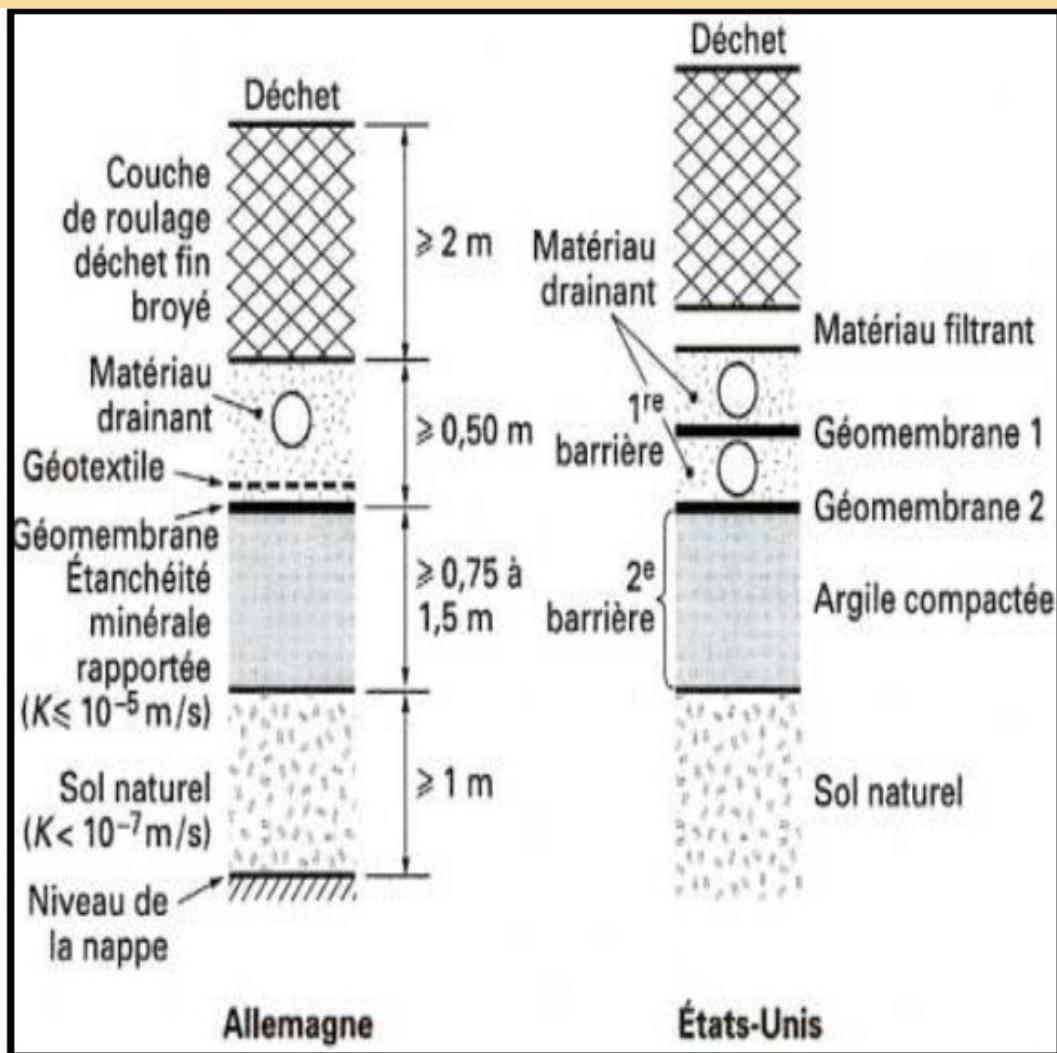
Etanchéité de fond de la décharge, Bordes 1995
